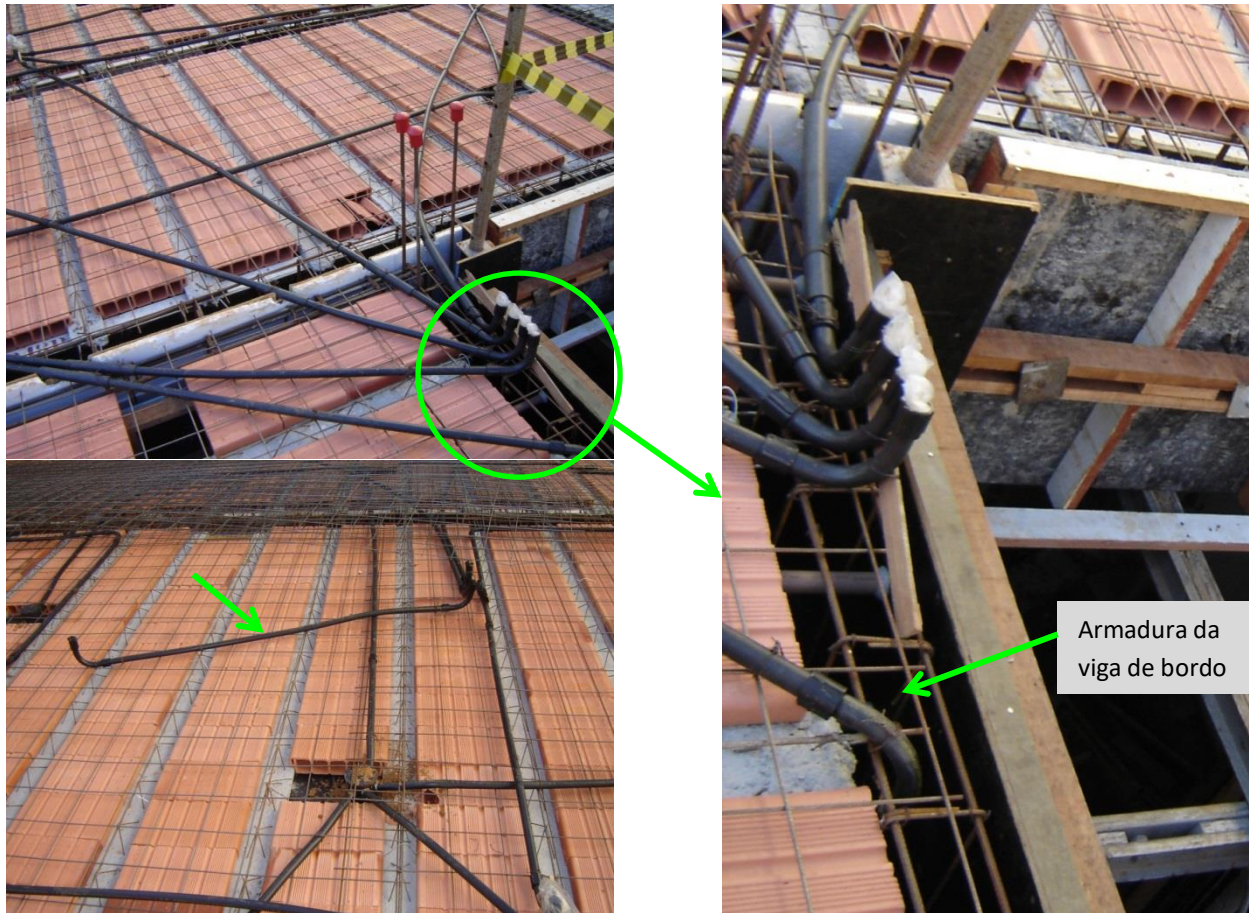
Esquerda superior*: Vista dos eletrodutos que ficarão embutidos na laje com detalhe da mudança de direção. *Direita*: ampliação do detalhe anterior com eletrodutos e curvas que ficarão embutidos na viga de bordo e na parede construída sobre a viga (4 eletrodutos que sobem pela parede do andar e 1 eletroduto que desce pela parede do andar inferior). *Esquerda inferior*: destaque para o eletroduto embutido na laje de piso que conecta duas tomadas baixas localizadas em paredes que serão apoiadas na laje. Fonte: acervo da disciplina AUT0190.
